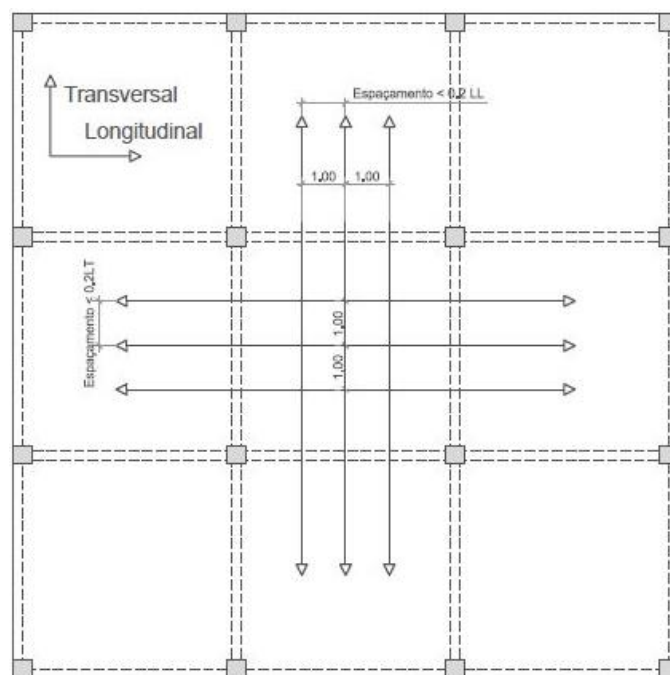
Determinação do espaçamento longitudinal e vertical
